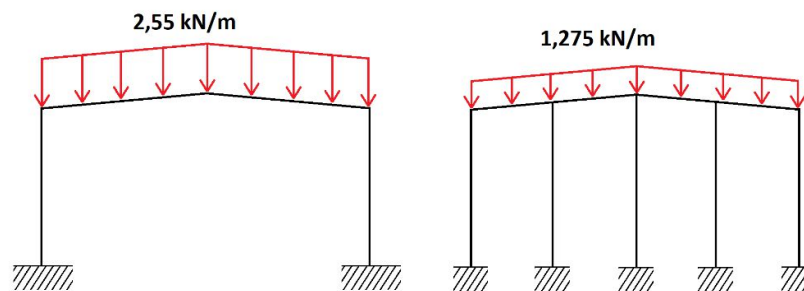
Peso propio sobre los pórticos interiores y de fachada
